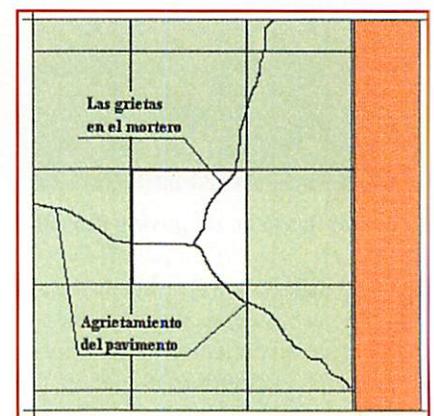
Aspecto en la planta de la fisuración de las baldosas. Al arrancar una baldosa la fisura continúa en el mortero.
